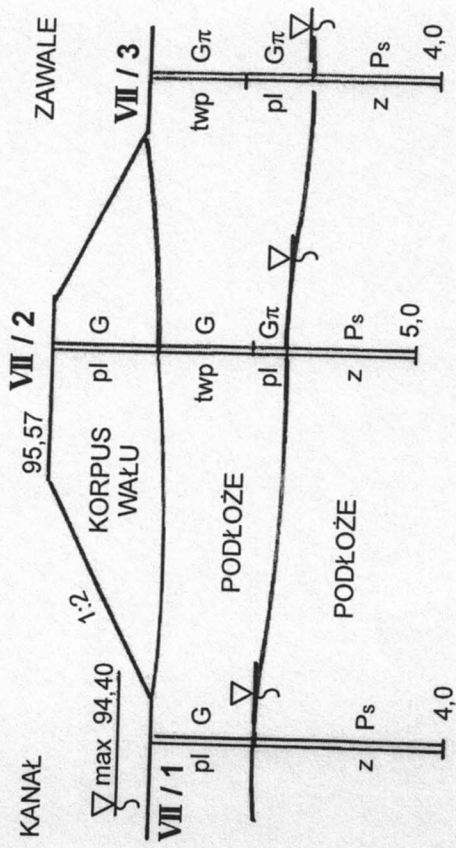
WAŁ LEWY PRZEKROJE GEOTECHNICZNE
